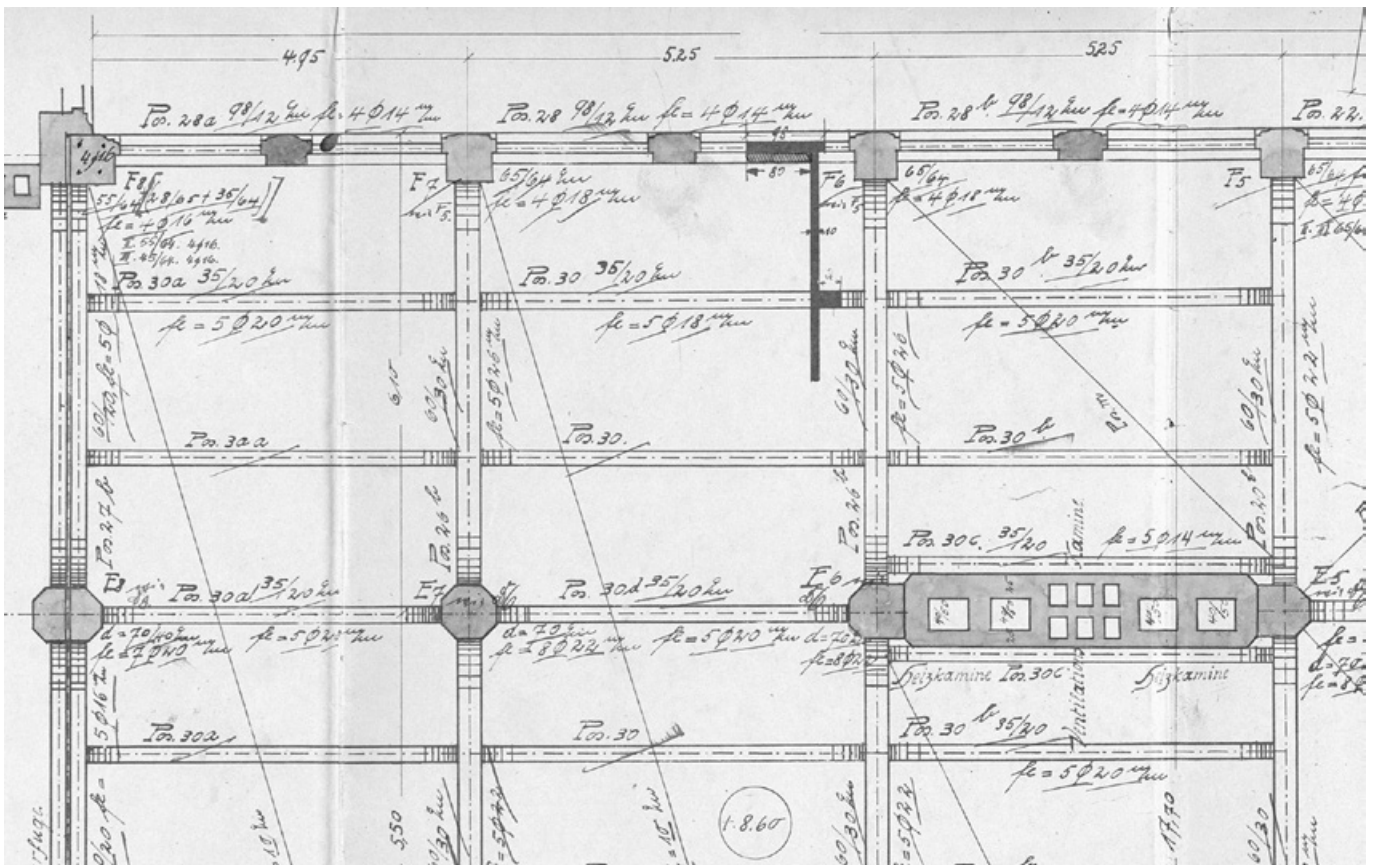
Originaler Positionsplan der Decke über dem 1. Obergeschoss mit Korrektüreinträgen (StadtAM, DE-1992-LBK-19330).
